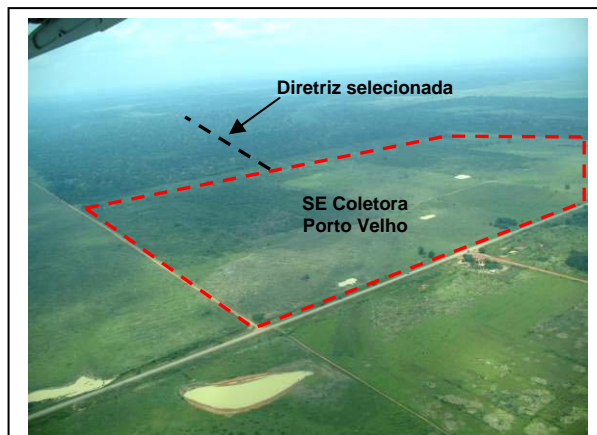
Vista parcial do terreno da SE Coletora Porto Velho, lindeiro à BR-364.
